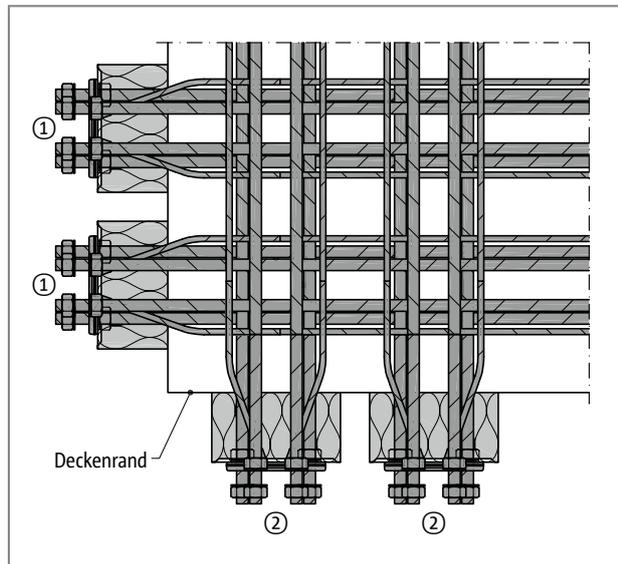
Schöck Isokorb® XT Typ SK: Außenecke
